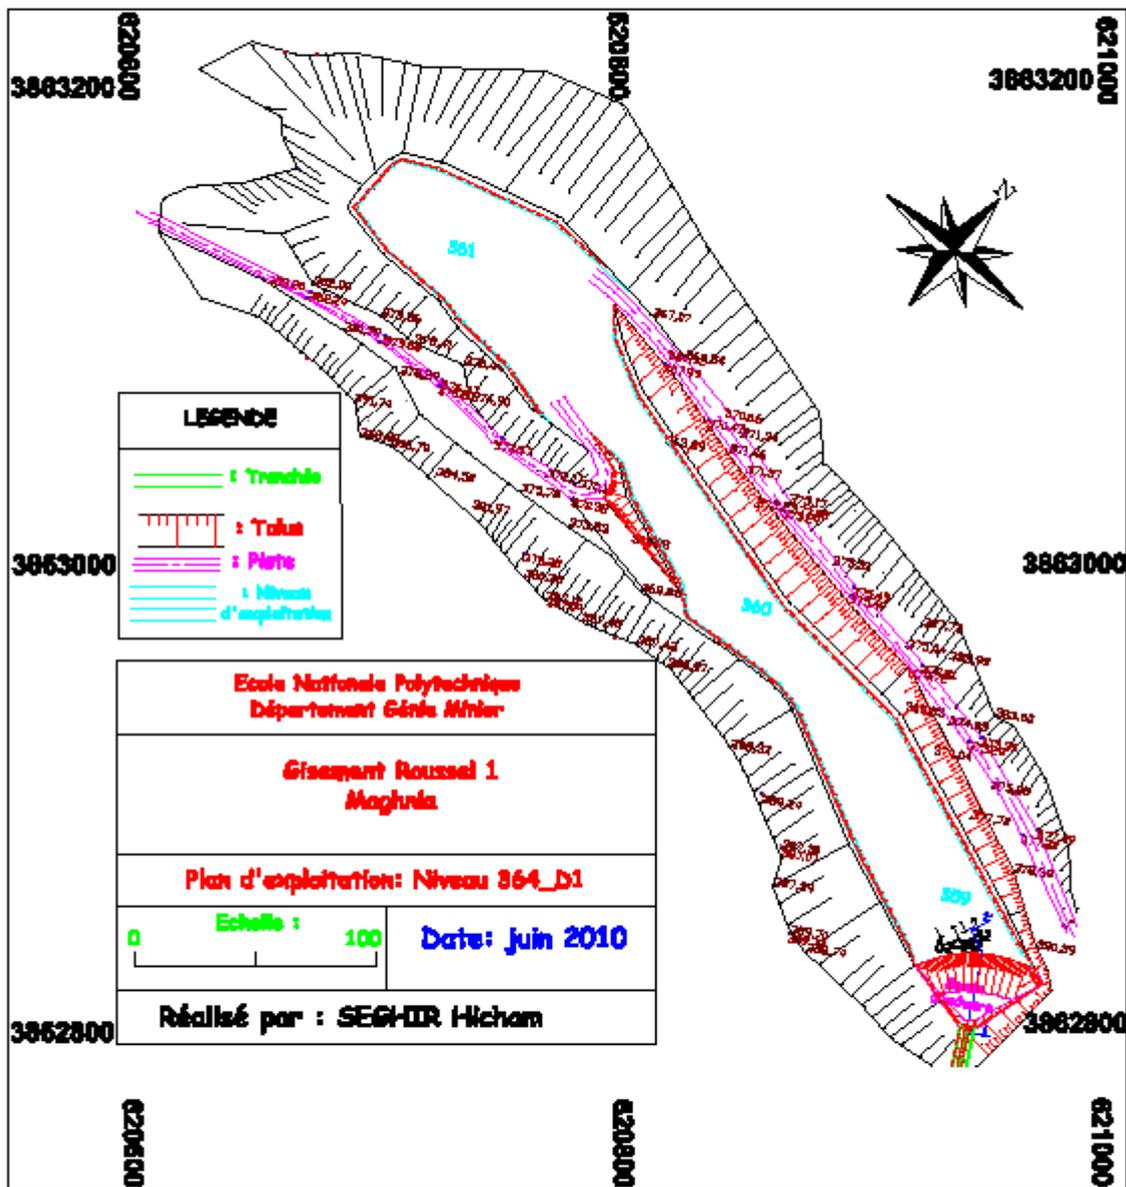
Plan d'exploitation, Niveau 361\_358
